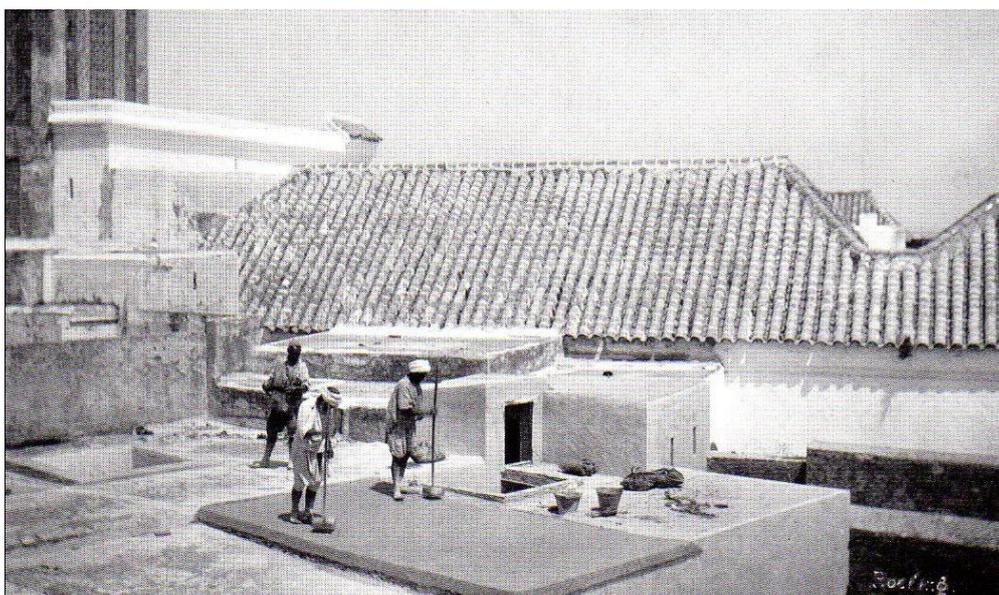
Trabajadores arreglando un tejado (Abensur 2009).
